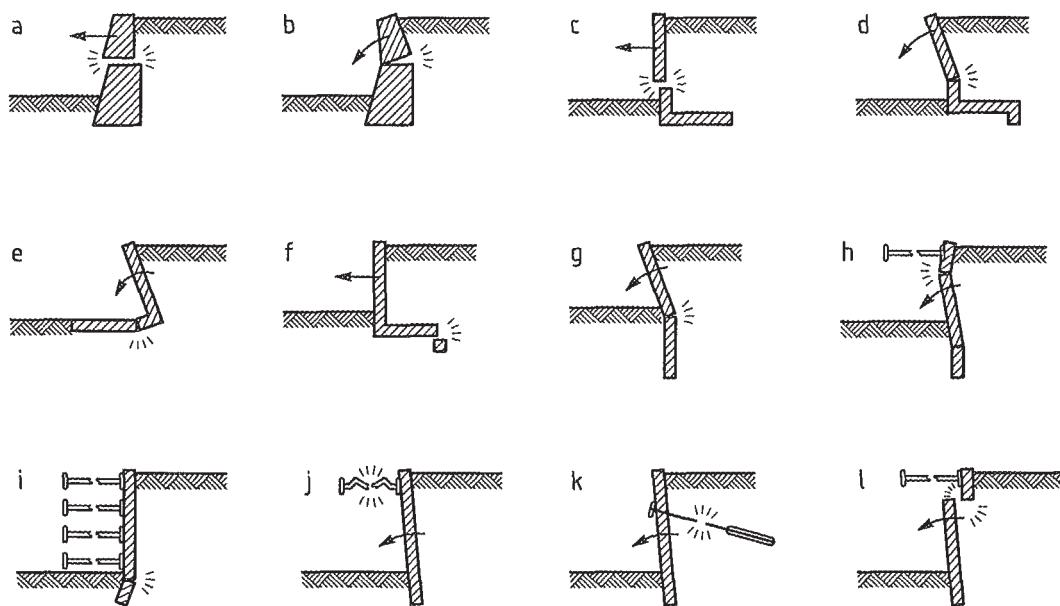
Eksempel på brudmåde for lodret brud af støttevægge
